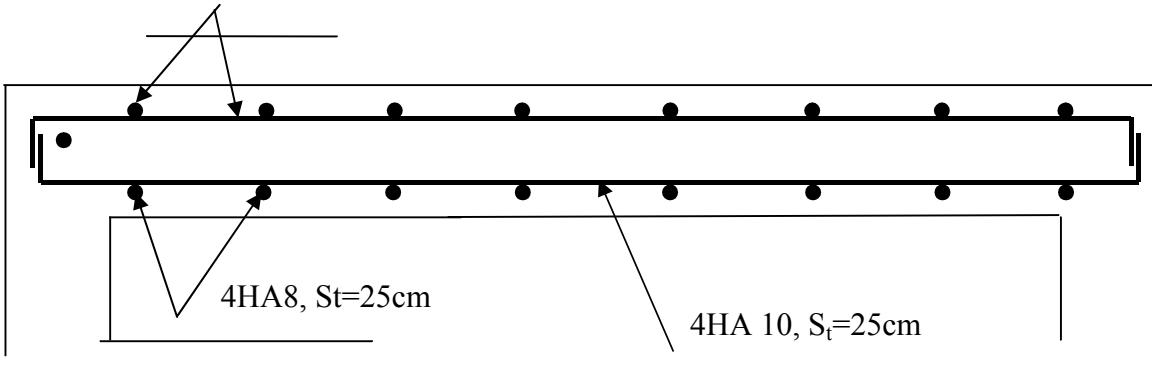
Plan de ferrailage de la salle machine suivant yy
